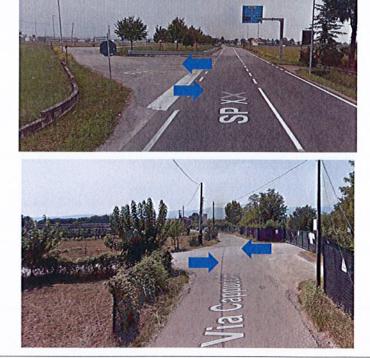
Dall'alto verso il basso, immissione da via Braghettone su SP 122 e attraversamento via Cappuccini all'ingresso di cava Vianelle
